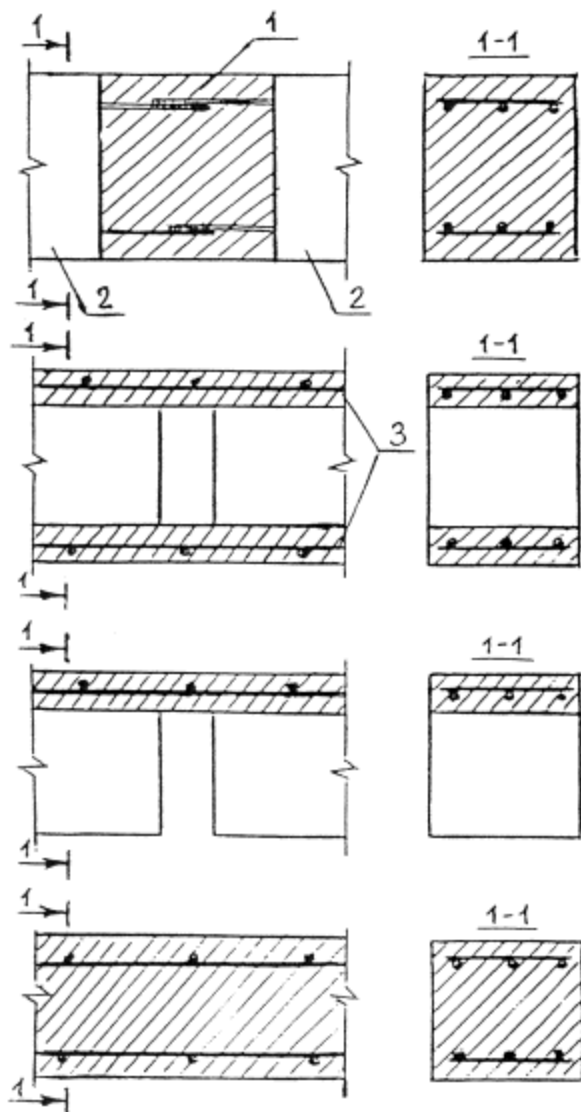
Конструктивные решения соединений элементов мелкозаглубленных ленточных фундаментов:
